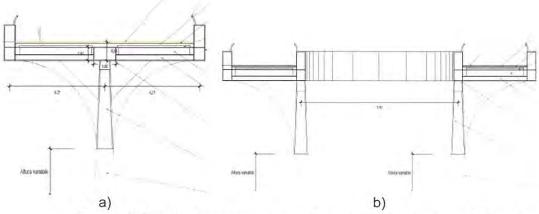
Tipo de columnas respecto a su número de ramales, a) columna de 4 ramales, b) columna de tres ramales en zona de óculo.
